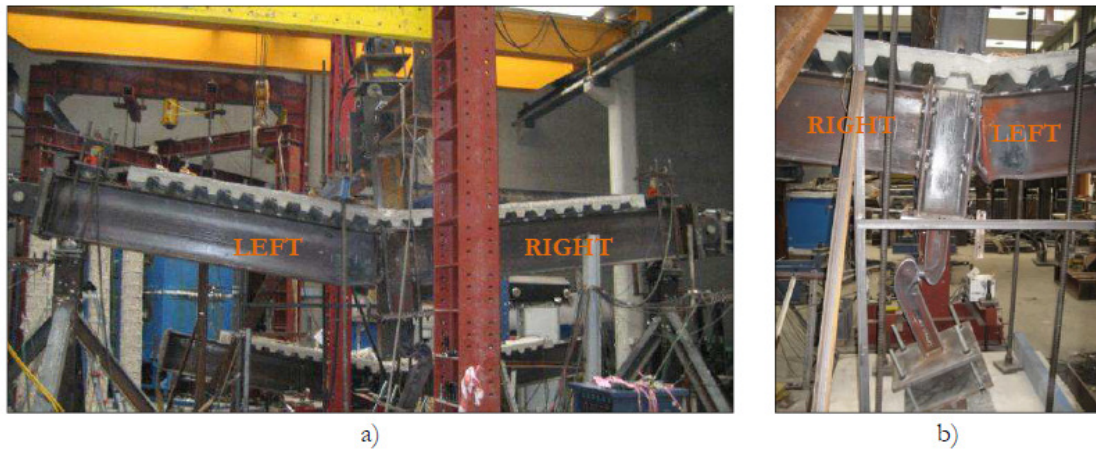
a) Deformações da estrutura, b) Detalhe do colapso do pilar inferior.
